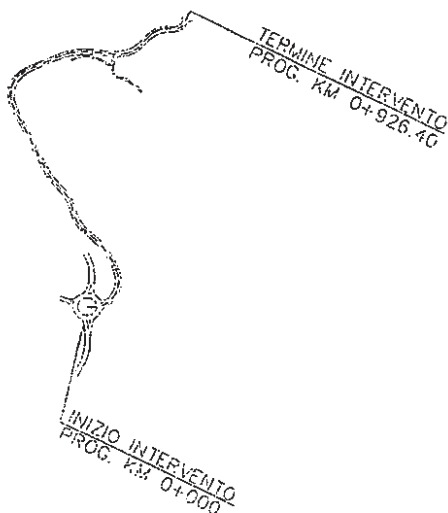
Schema planimetrico TG-CO-04 / Raccordo di Casnate
